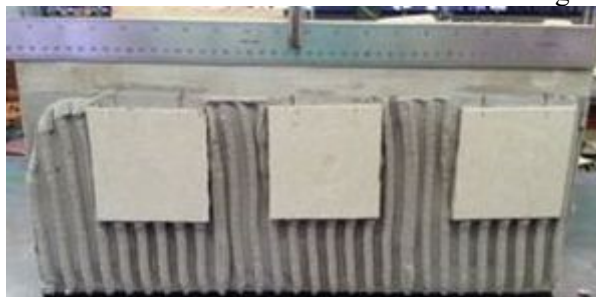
Configuração final do ensaio de deslizamento de uma das argamassas testadas
